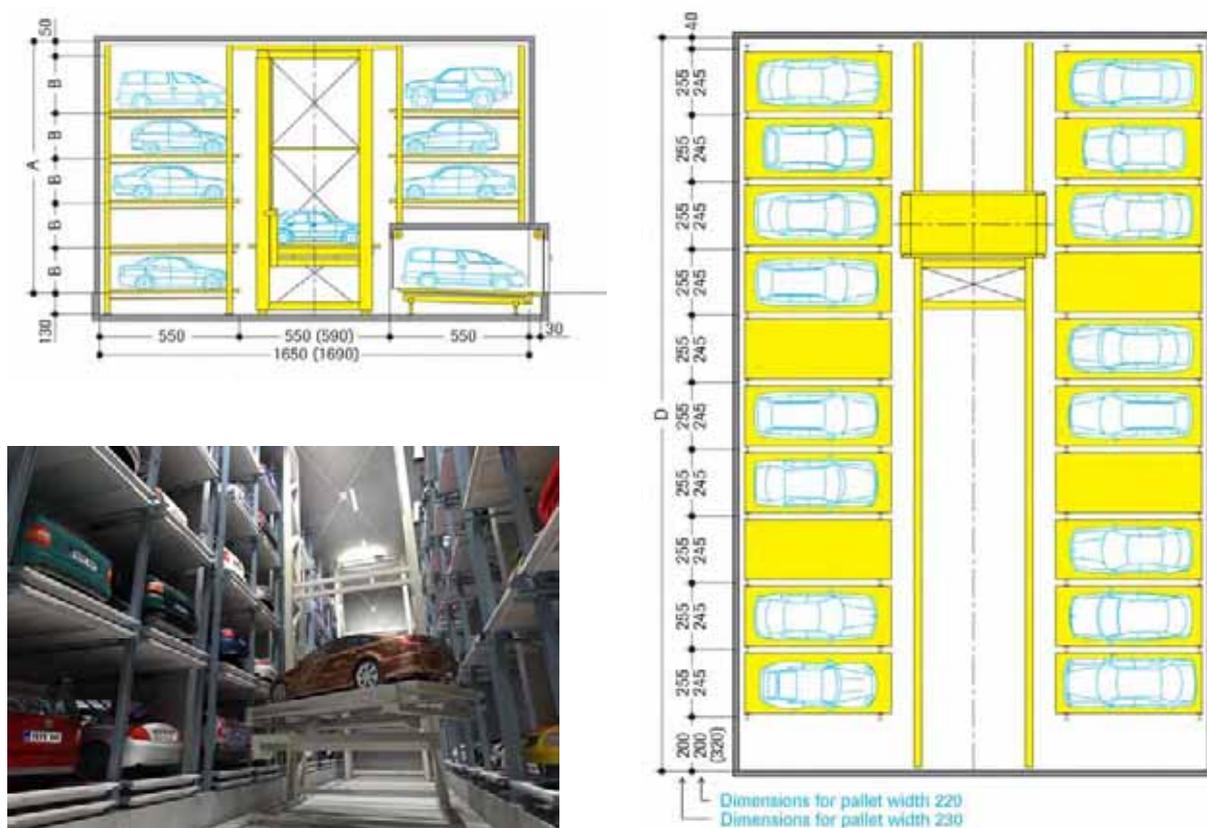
Sección, planta y vista de un sistema *Multiparker* con disposición transversal de los vehículos aparcados.
